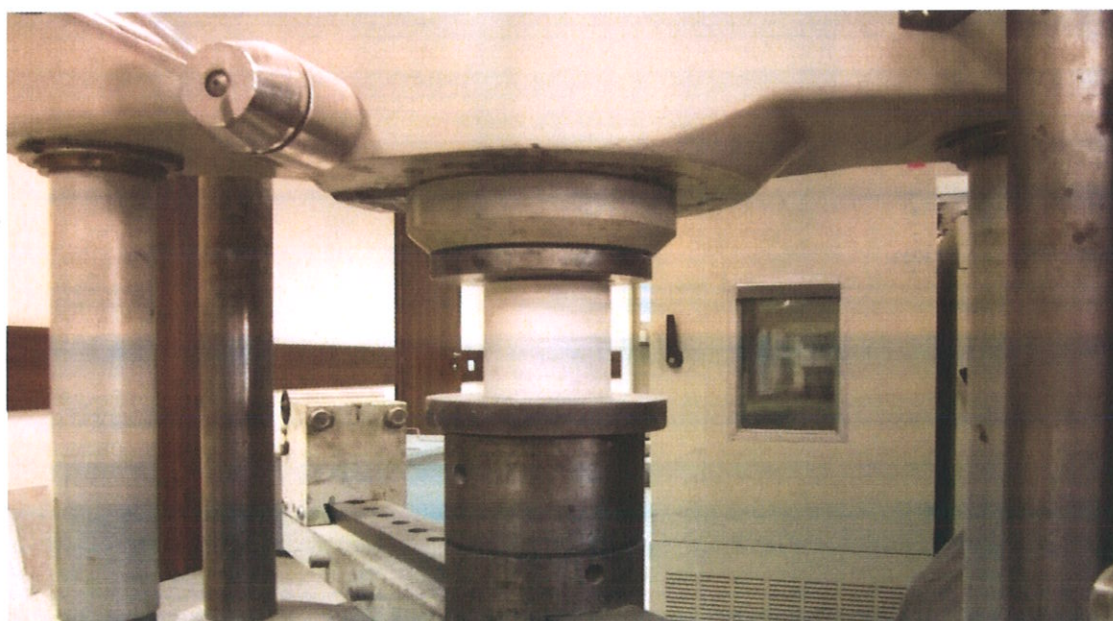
Установка образца-цилиндра, изготовленного из стенового блока ISTKULT для испытаний на сжатие.
